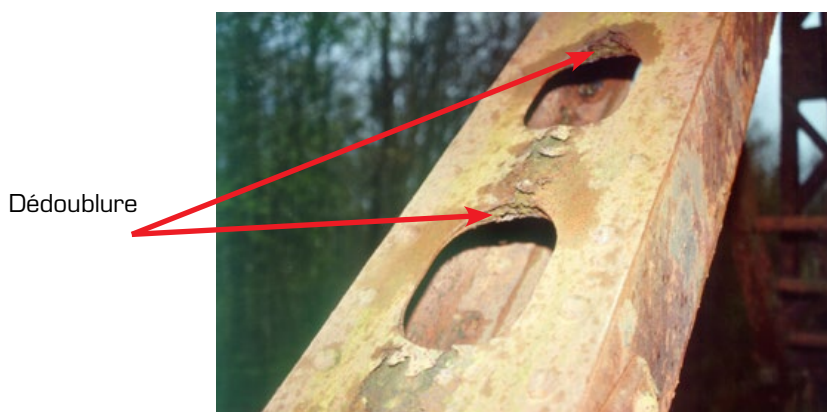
Corrosion foisonnante sur dédoubleure sur une poutre caisson élégie (photo Jean-Paul PERSY).
